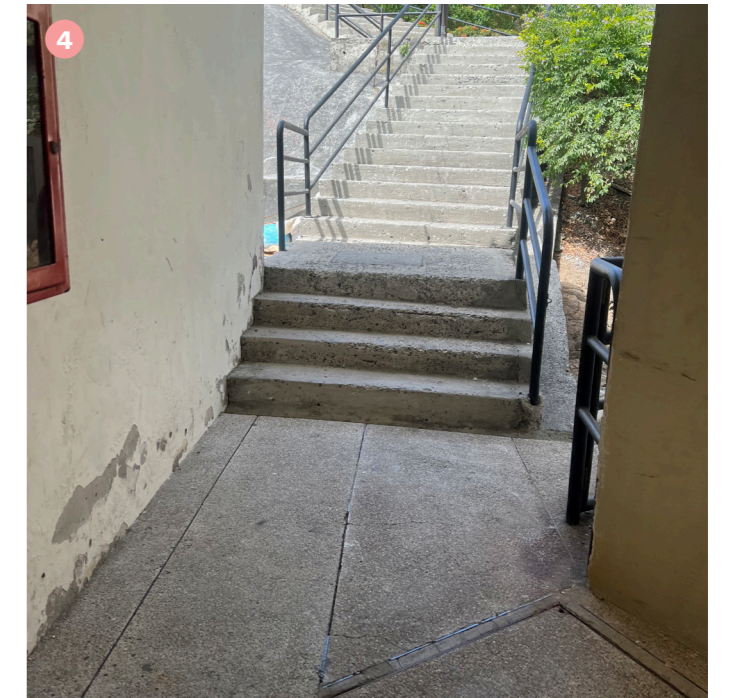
Ingreso a la planta alta 2 desde el parqueadero de la Facultad de Empresariales.
